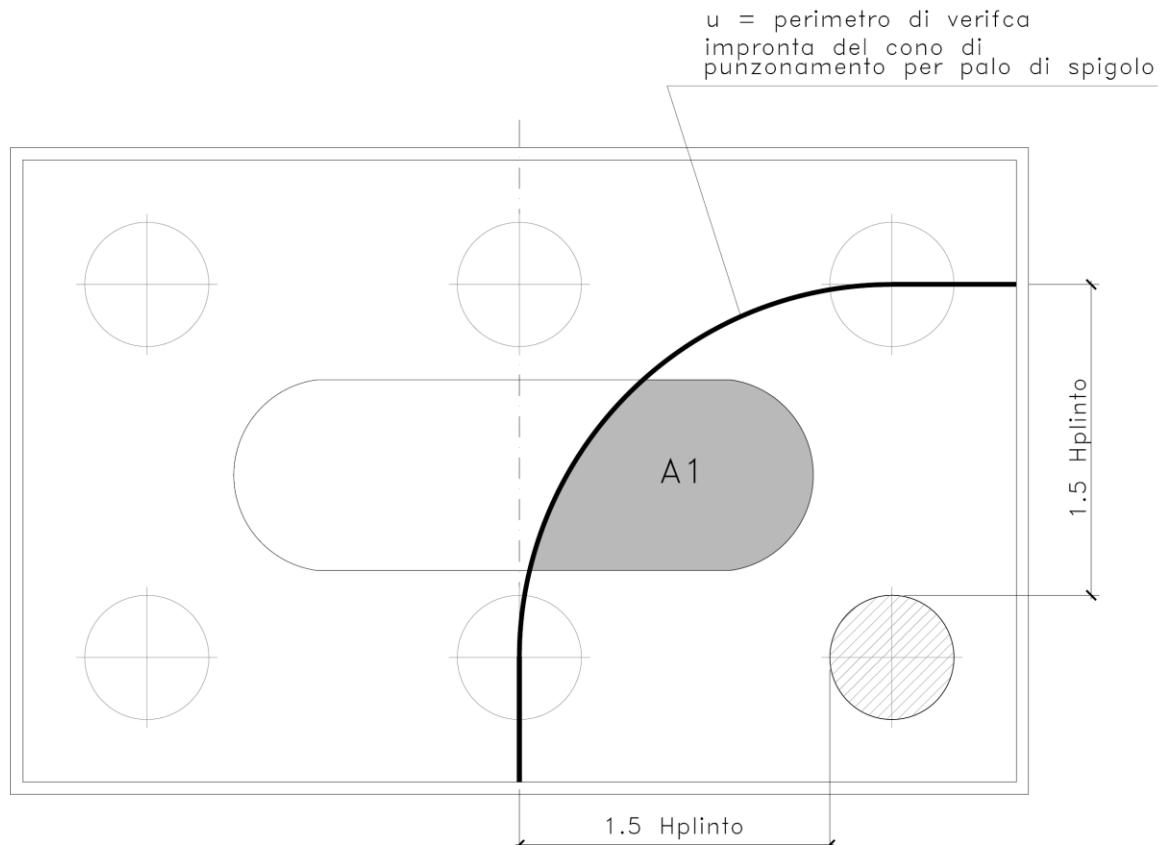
Vista in pianta – Perimetro di verifica - Palo di spigolo
